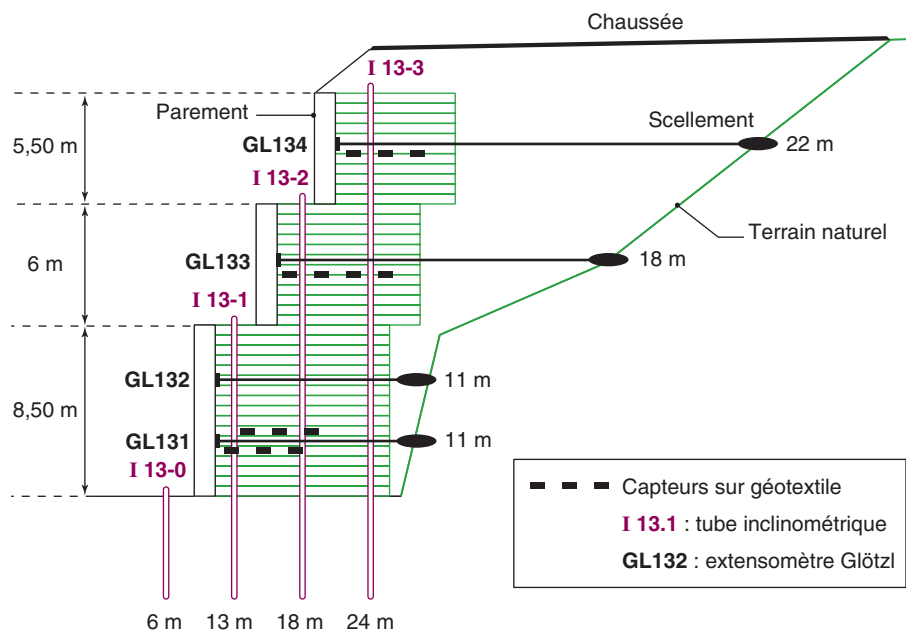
Exemple d'un ouvrage en remblai renforcé, instrumenté pendant la construction.
